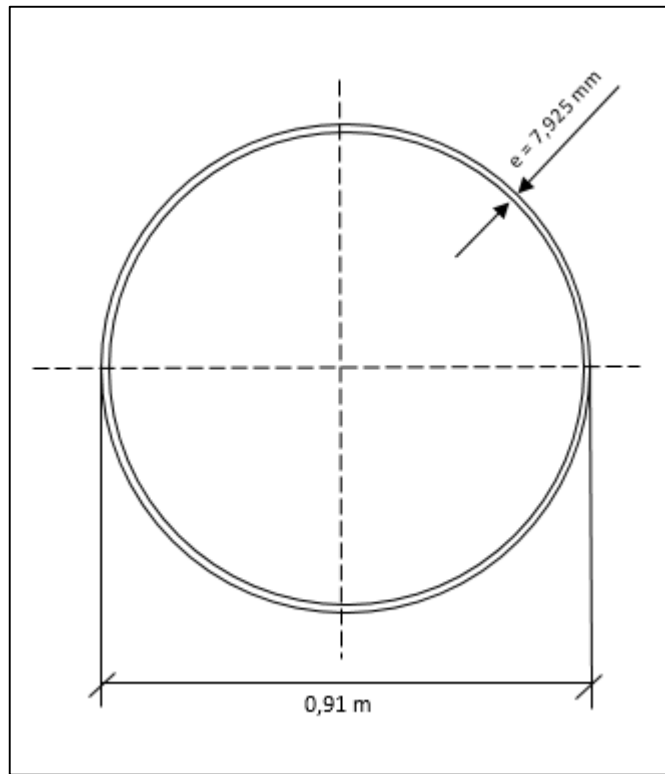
Sección transversal de la tubería forzada. Diámetro y espesor comercial
